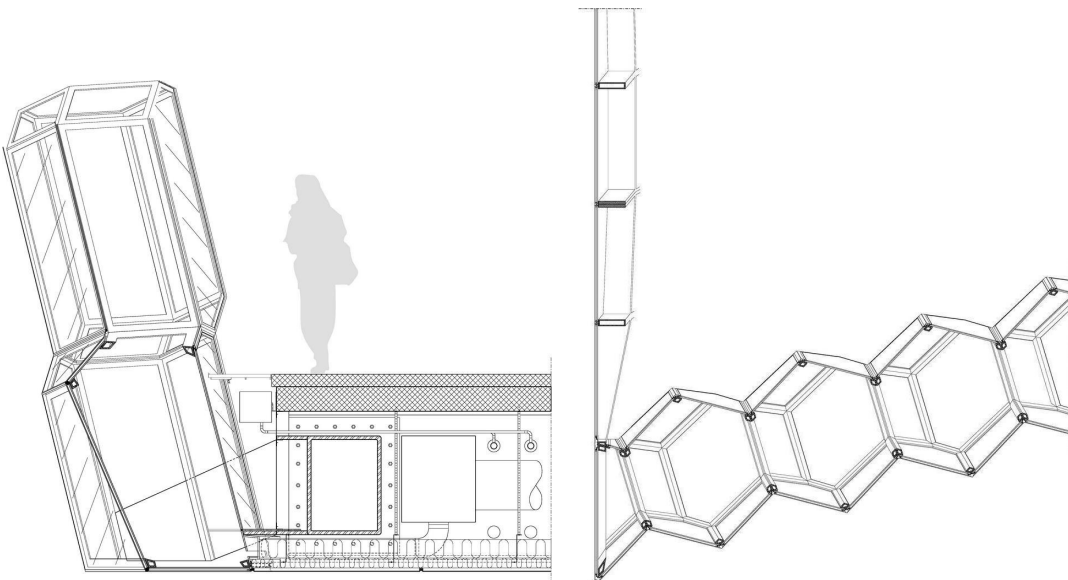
Detalle de sección de articulación de los casi ladrillos a edificio y detalle en planta de unión entre los casi ladrillo.
